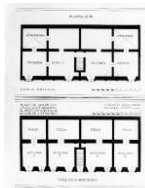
Planta arquitectónica del prototipo de vivienda de alquiler
